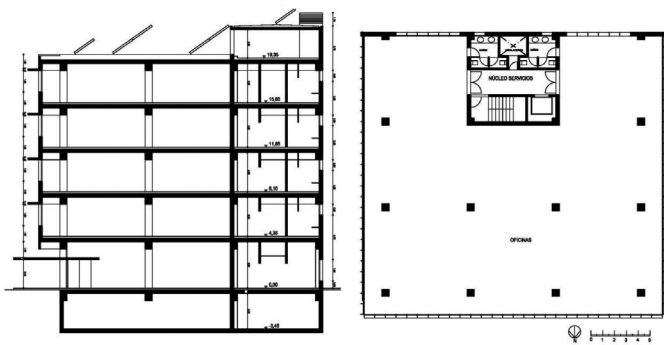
Edificio de oficinas analizado. Planta tipo y sección
